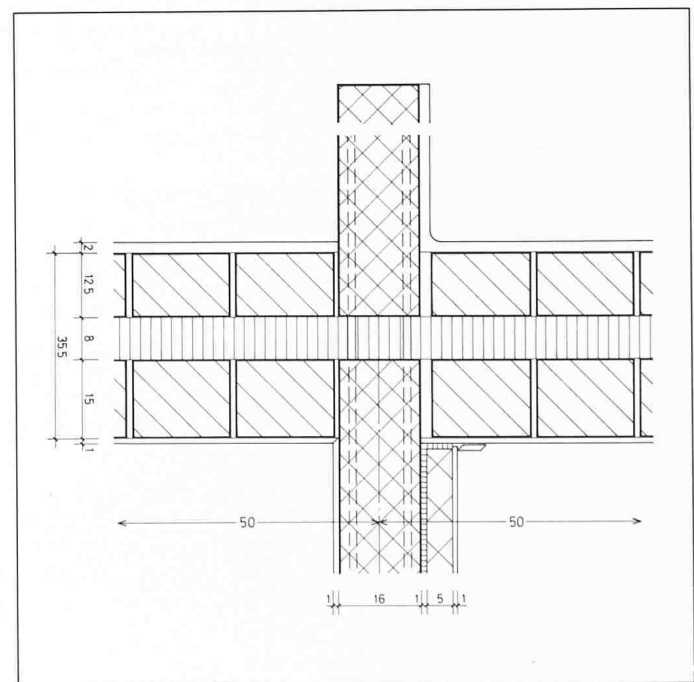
Zwei-Schalenmauerwerk, Detail Balkonauskragung mit durchgehendem Stahlkorb
